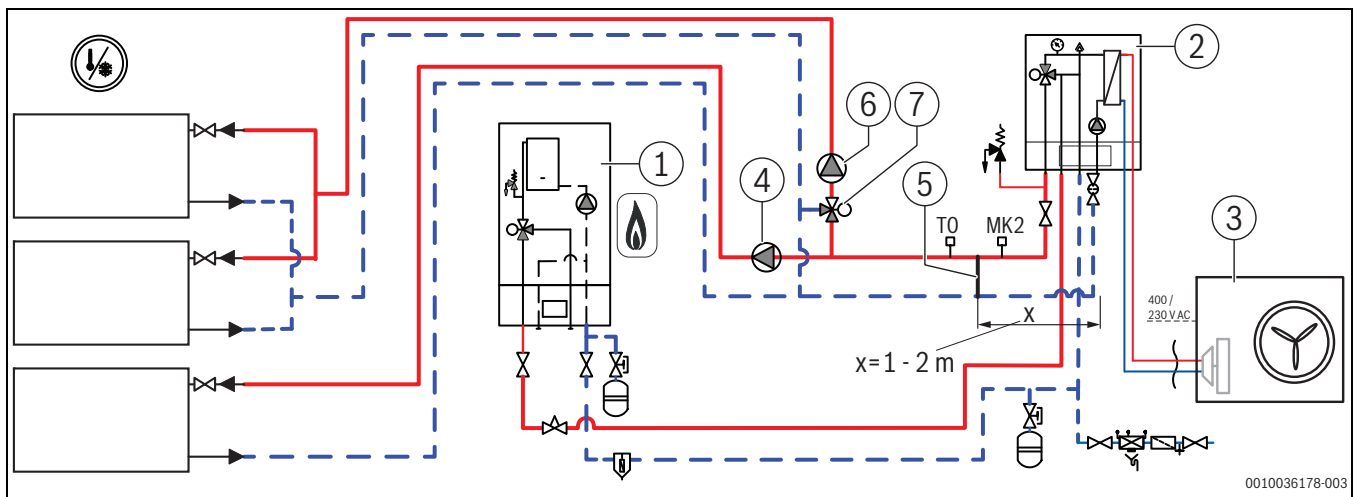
Hydraulisch schema van een installatie (1 cv-groep, zonder bypass; voorbeeld)
